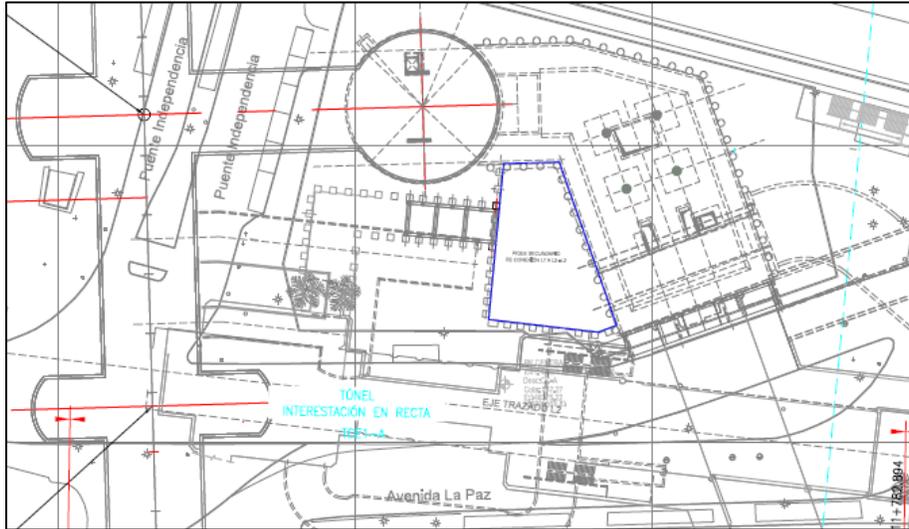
Planta Emplazamiento Pique Secundario de Estación Cal y Canto y Conexión con Línea 3 y Línea 2.
